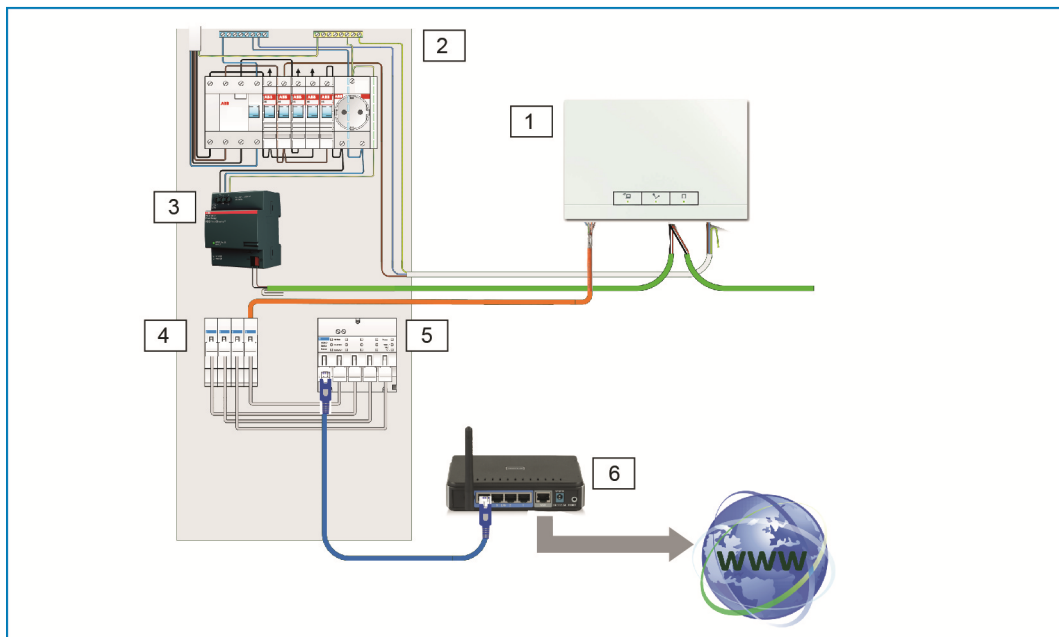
Collegamento tramite cavo di installazione in caso di cablaggio strutturato
